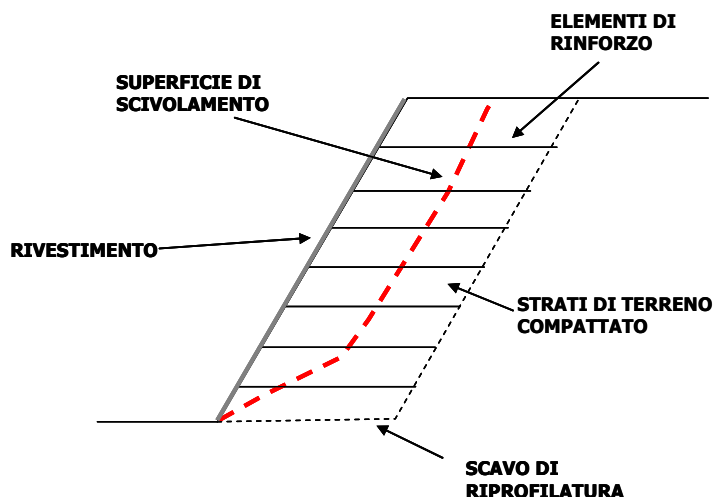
Utilizzo delle terre rinforzate in un intervento di riprofilatura. -
